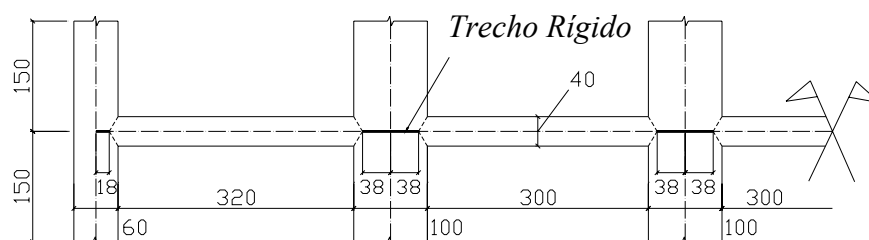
Geometria da viga, Caso 11 (dimensões em cm)
